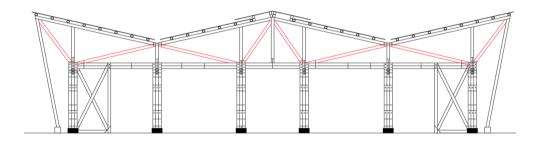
Secciones de Diagonales de Sobrecubierta en Vista Transversal. Fuente: [Propia]
